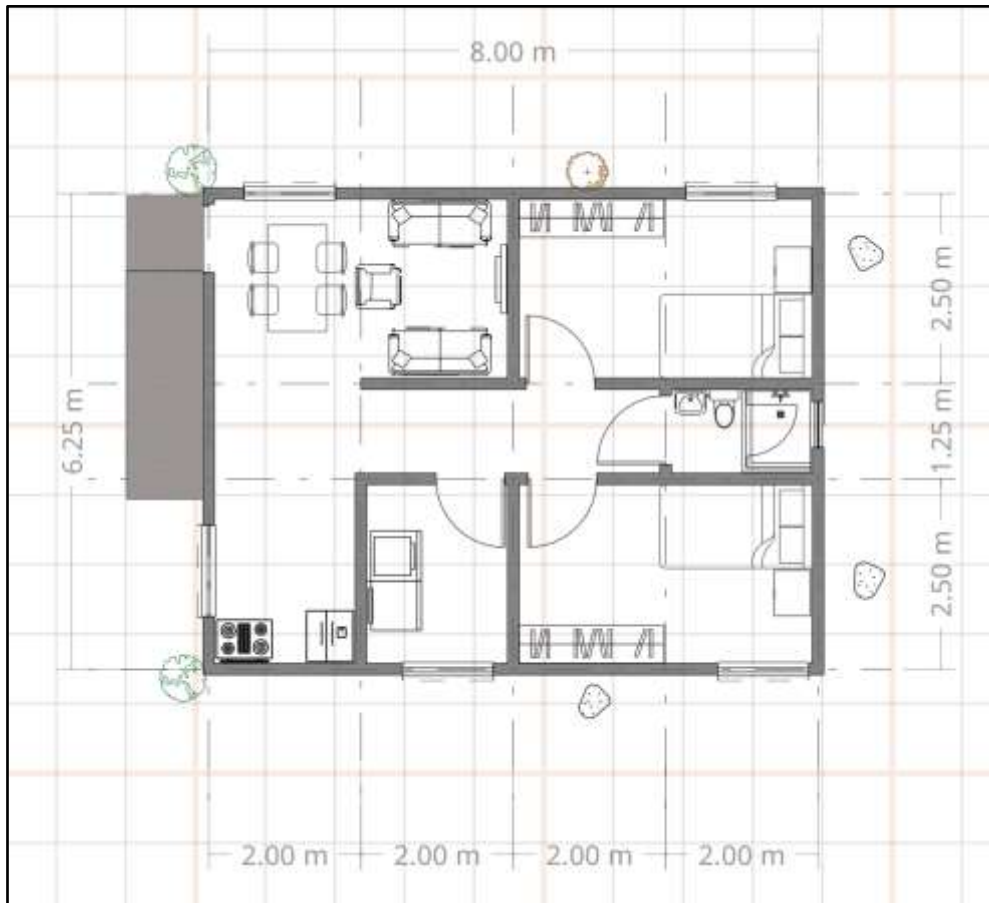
Plano arquitectónico de vivienda unifamiliar
